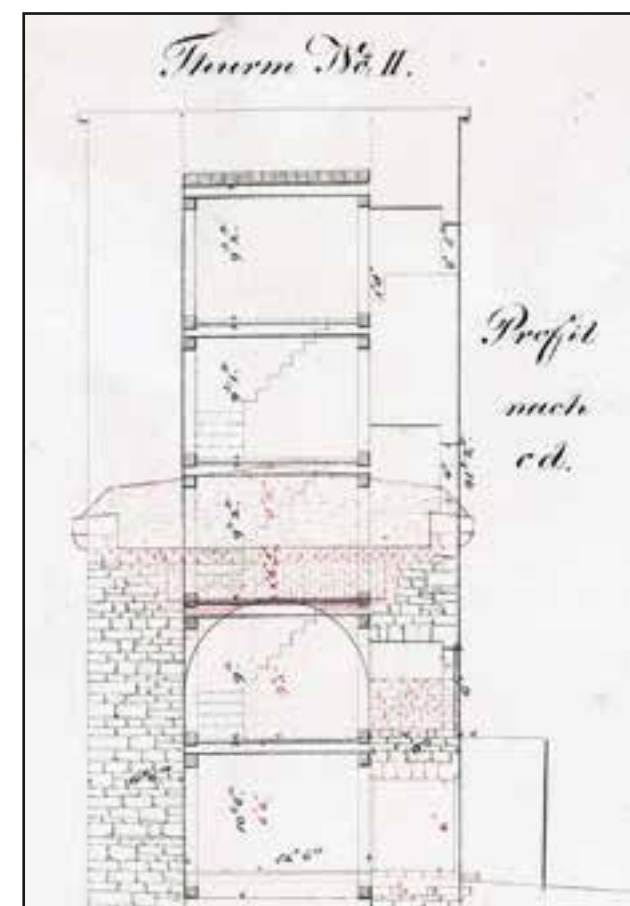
Plan zum Umbau des Pulverturms Nr. 2
